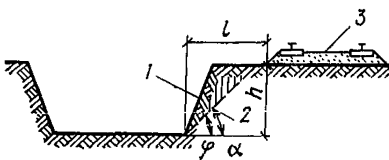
Схема размещения подкранового пути вблизи котлована, траншеи
